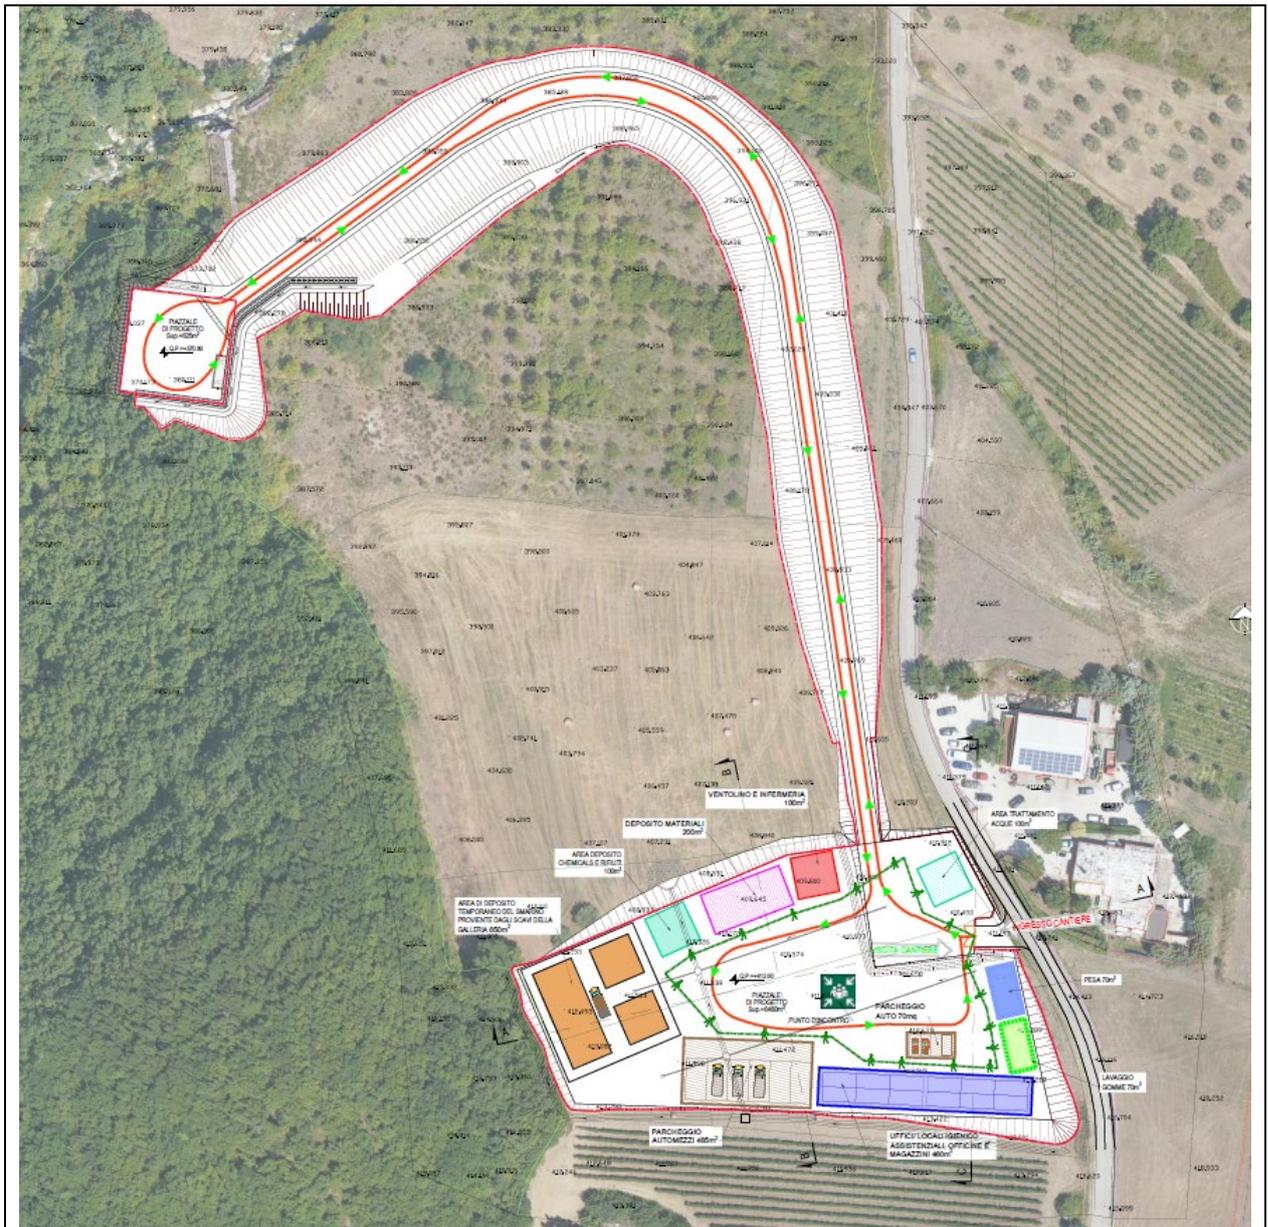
Layout cantiere scavo galleria discenderia laterale (COS2)
